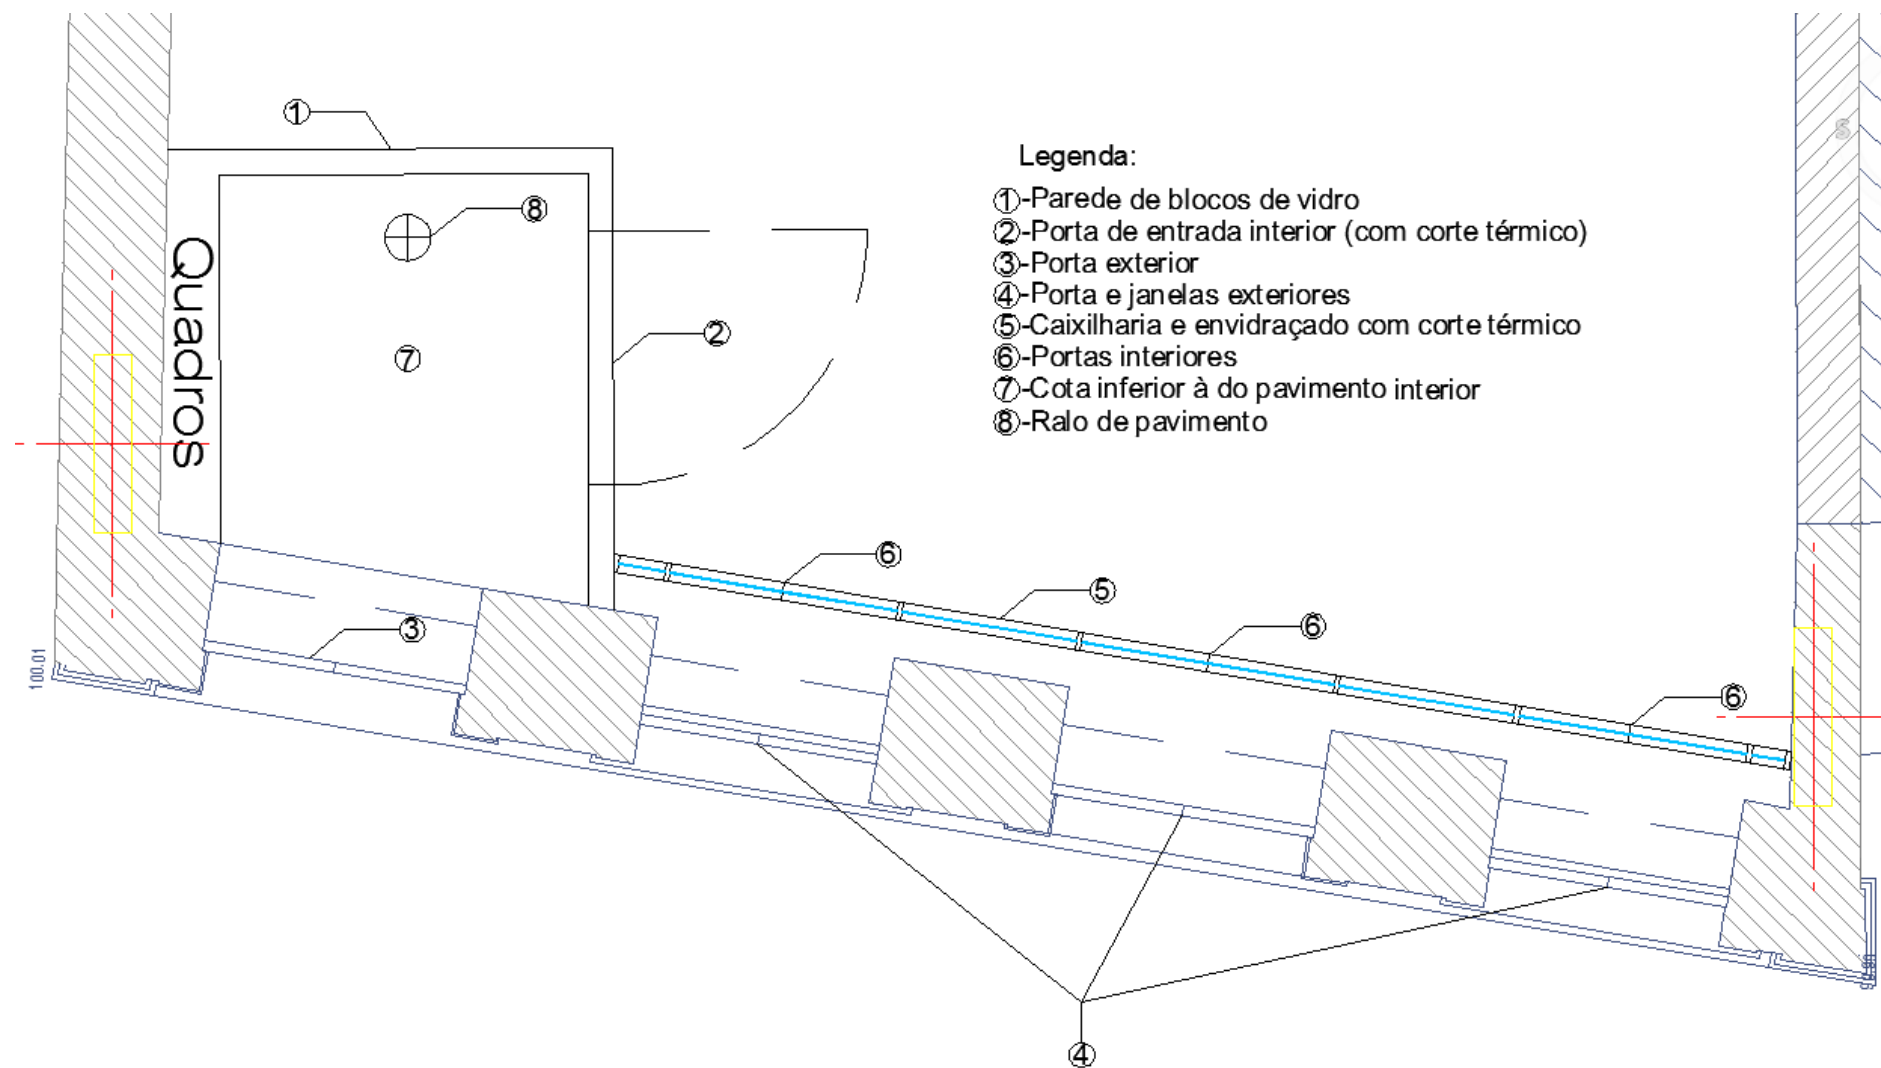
Representação em planta do isolamento interior da parede de fachada
